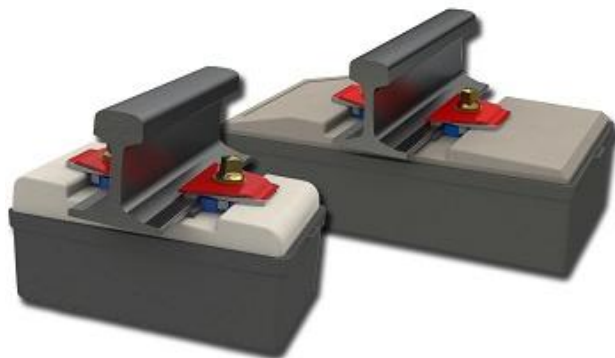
sistemas de bloques recubiertos de elastómero. Fuente: <http://www.sufetra.es>
